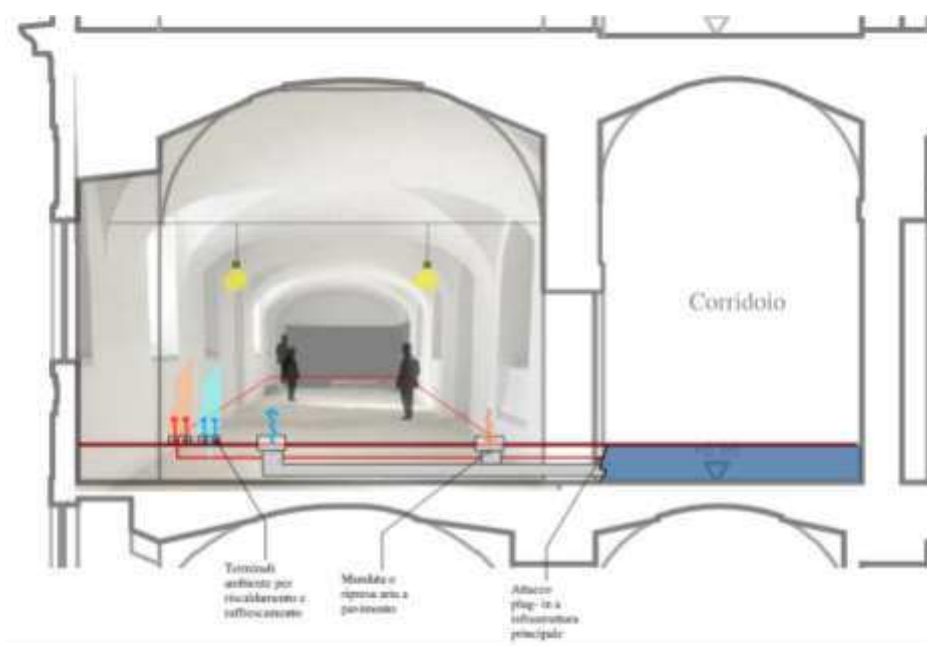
Box in box, tipo 3: Riscaldamento, raffrescamento e ventilazione a pavimento, UTA remota in locale tecnico
